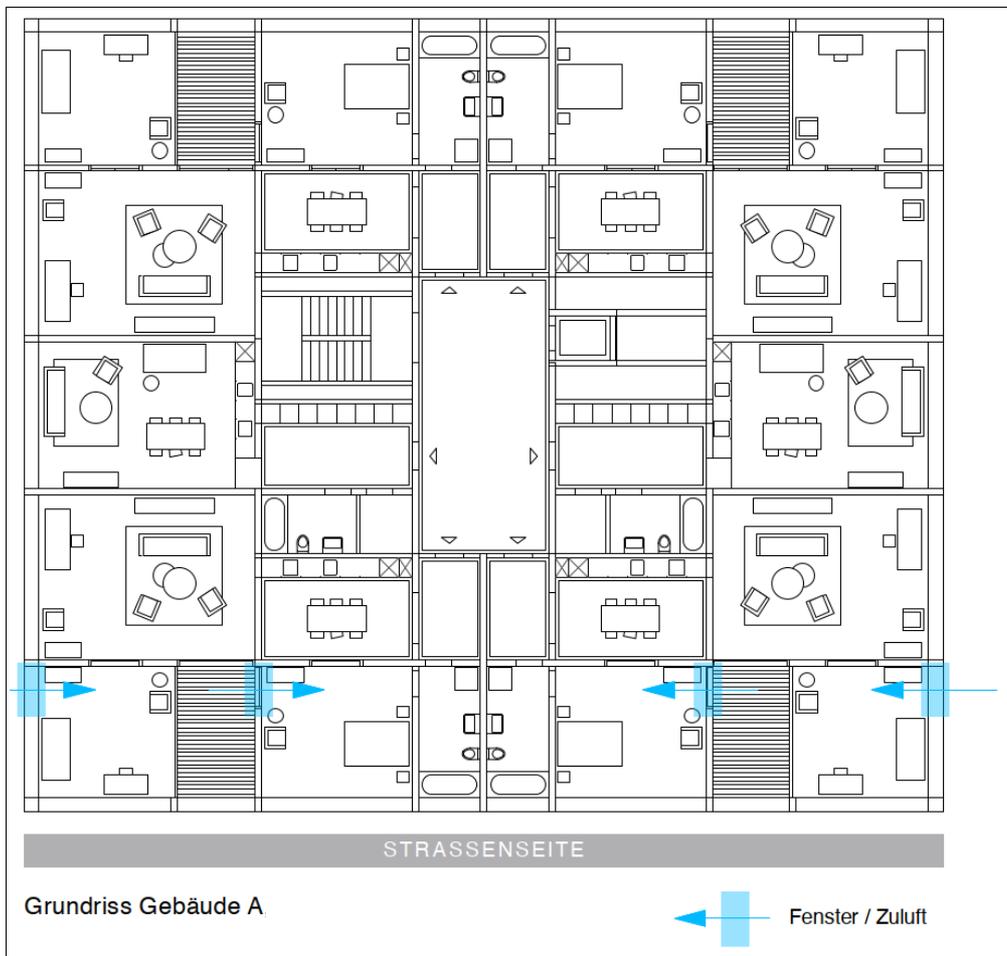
Lärmoptimierter Grundriss Gebäude A Richtprojekt
